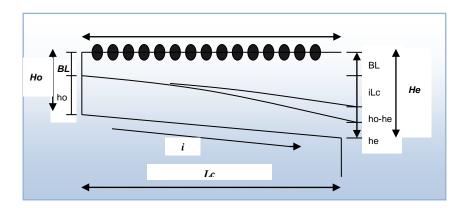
Perfil del canal de aducción (López Cualla, 1995)
